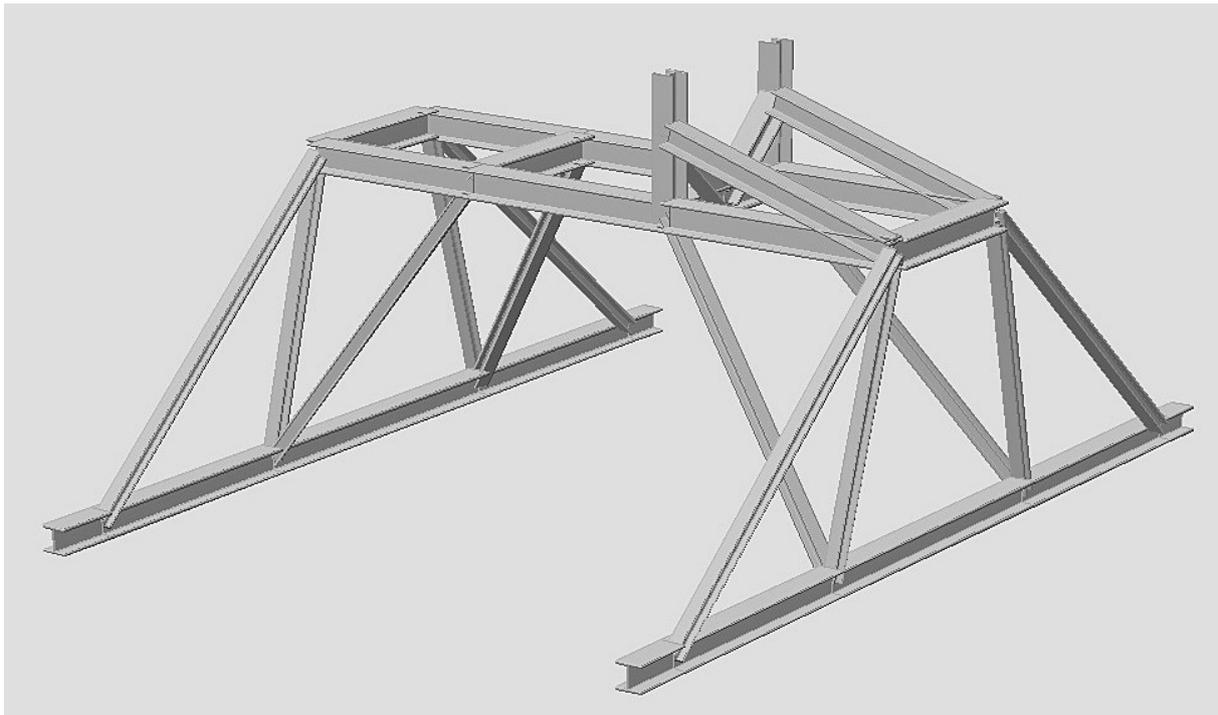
Auflagerrahmen im Dachstuhl des Zwischenflügels Nord mit Festlager in Längsrichtung und Federlagerung in Querrichtung
